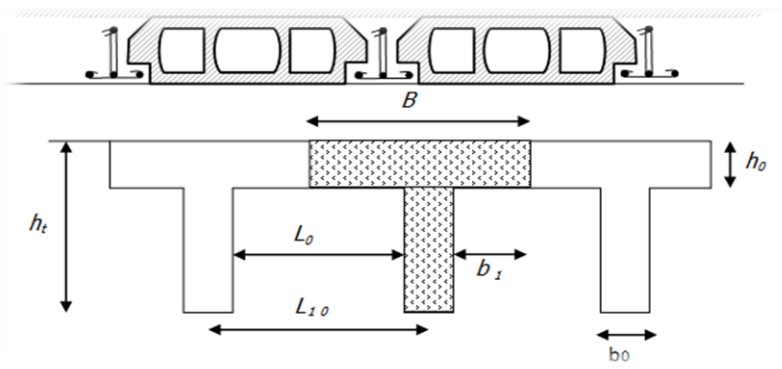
Dimensions d'un plancher à corps creux selon BAEL 91
